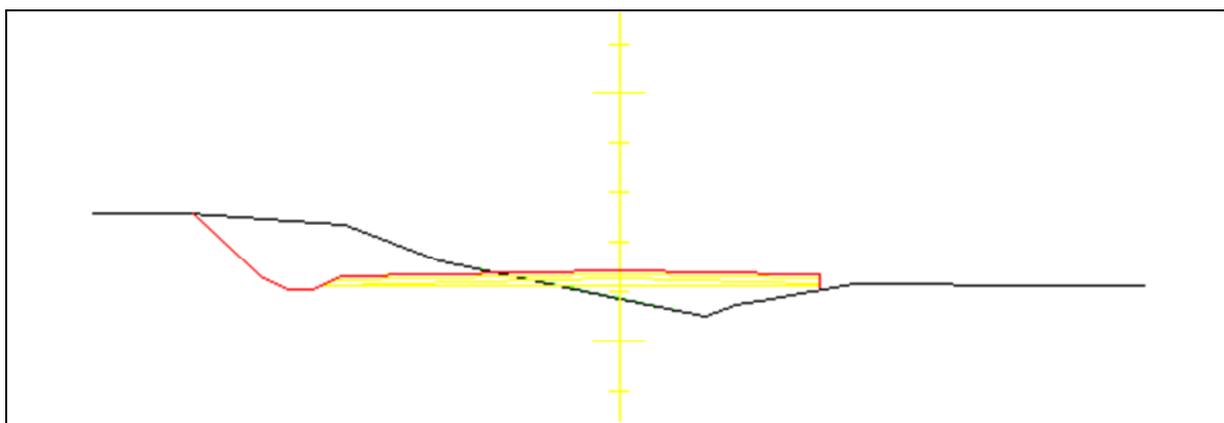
Exemple de profil en travers type obtenu à l'aide d'Autopiste.
